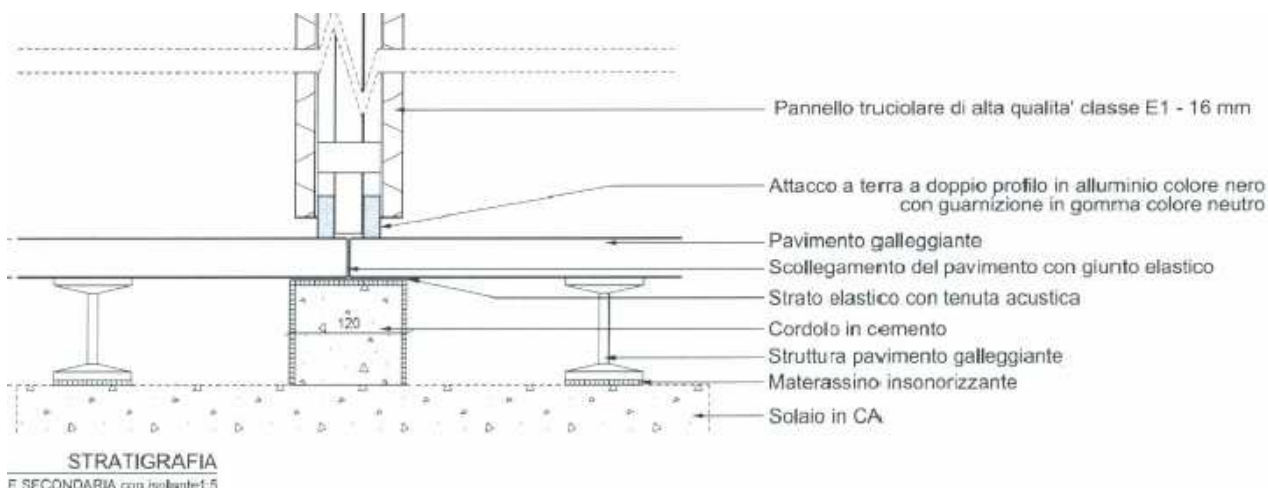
Interruzione della continuità del pavimento attraverso l'interposizione di un giunto elastico e dell'intercapedine del pavimento sopraelevato per la presenza di un cordolo in c.a. opportunamente sigillato
